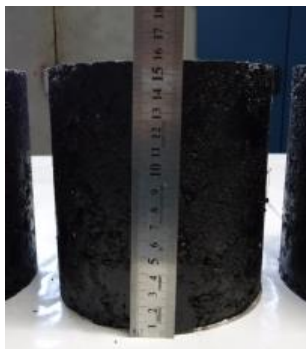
Máquina do ensaio da PCG e retirada do corpo de prova
